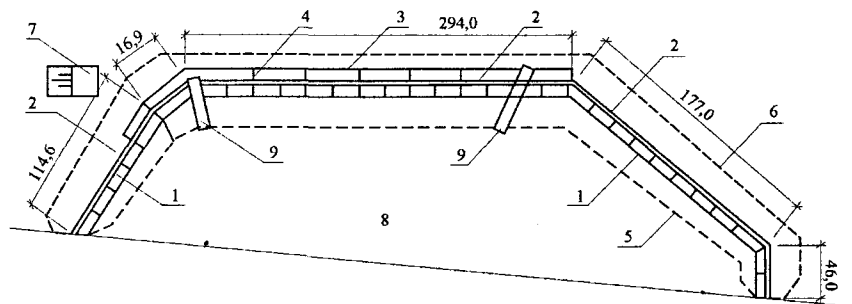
Схема перемычек котлована 1-ой очереди Бухтарминской ГЭС:
